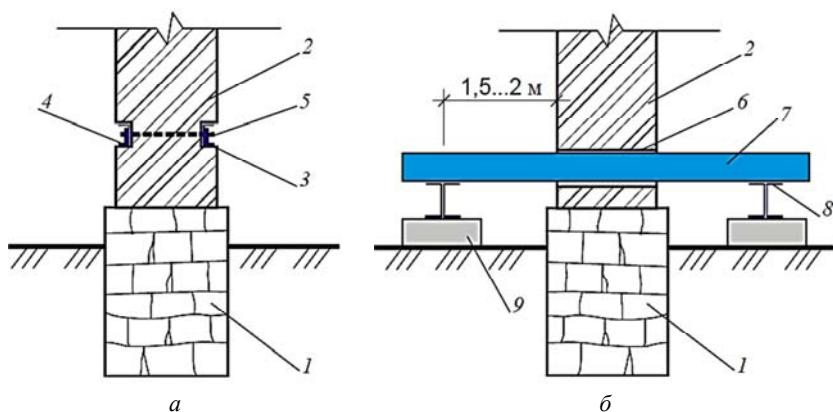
Полная разгрузка фундаментов с помощью:
